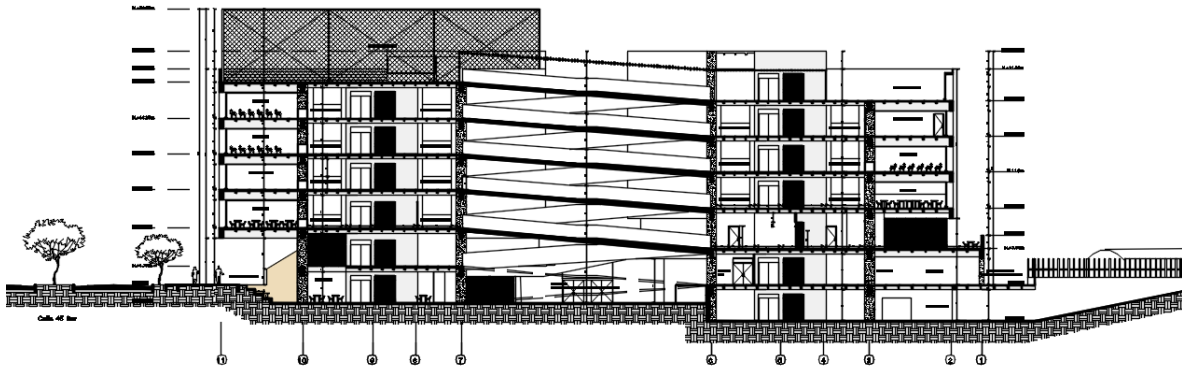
Proyecto arquitectónico – Corte Longitudinal.
